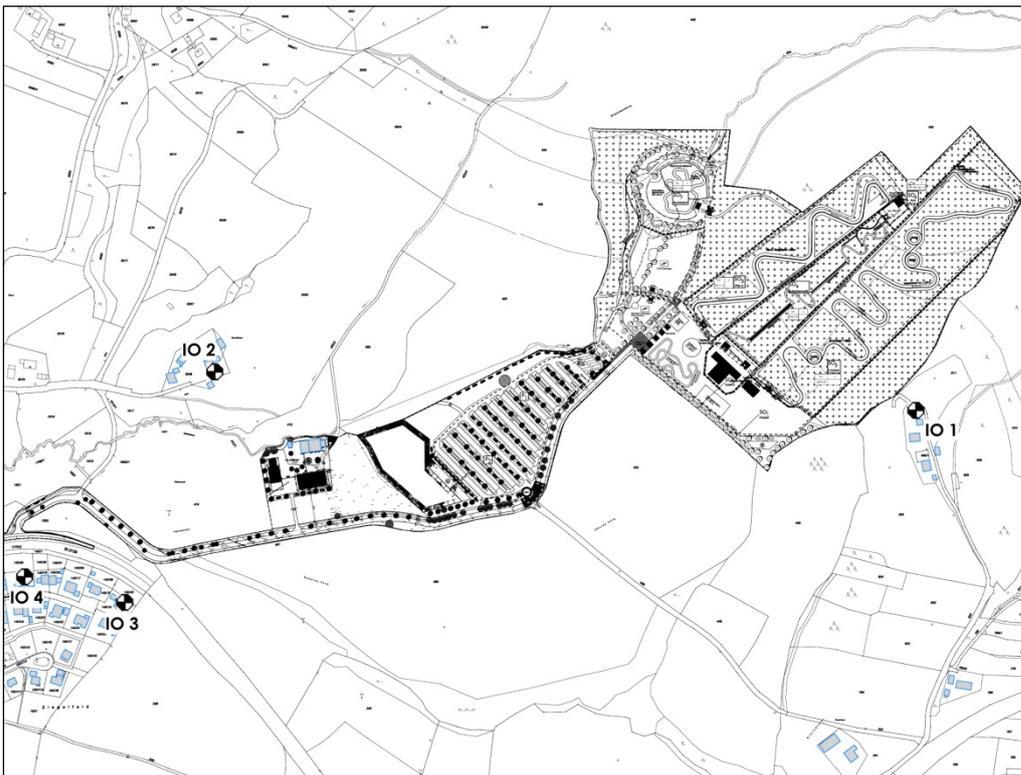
Lageplan mit Darstellung der maßgeblichen Immissionsorte
